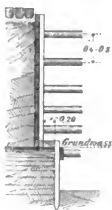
Betonschüttung bei starkem Grundwasserzudrang.
